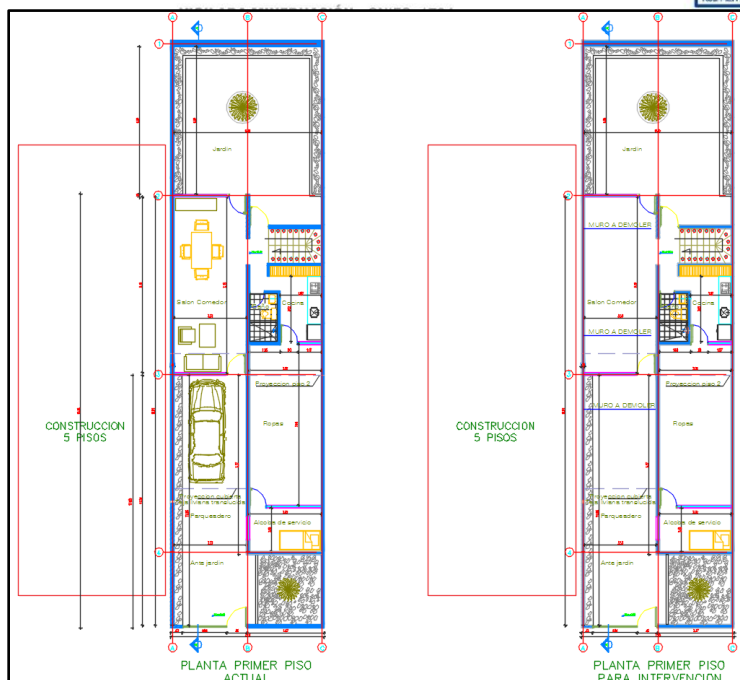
Planta Arquitectónica actual y a intervenir.
